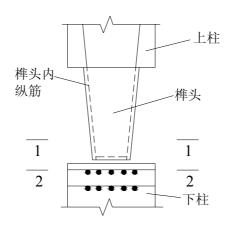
榫式柱连接施工吊装阶段验算截面
